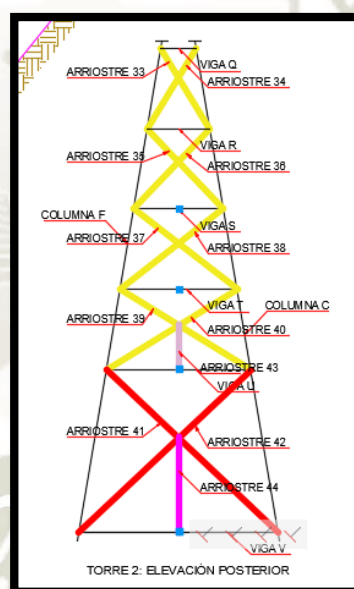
Columnas y arriostres de Torre 2 – posterior a reforzar.
